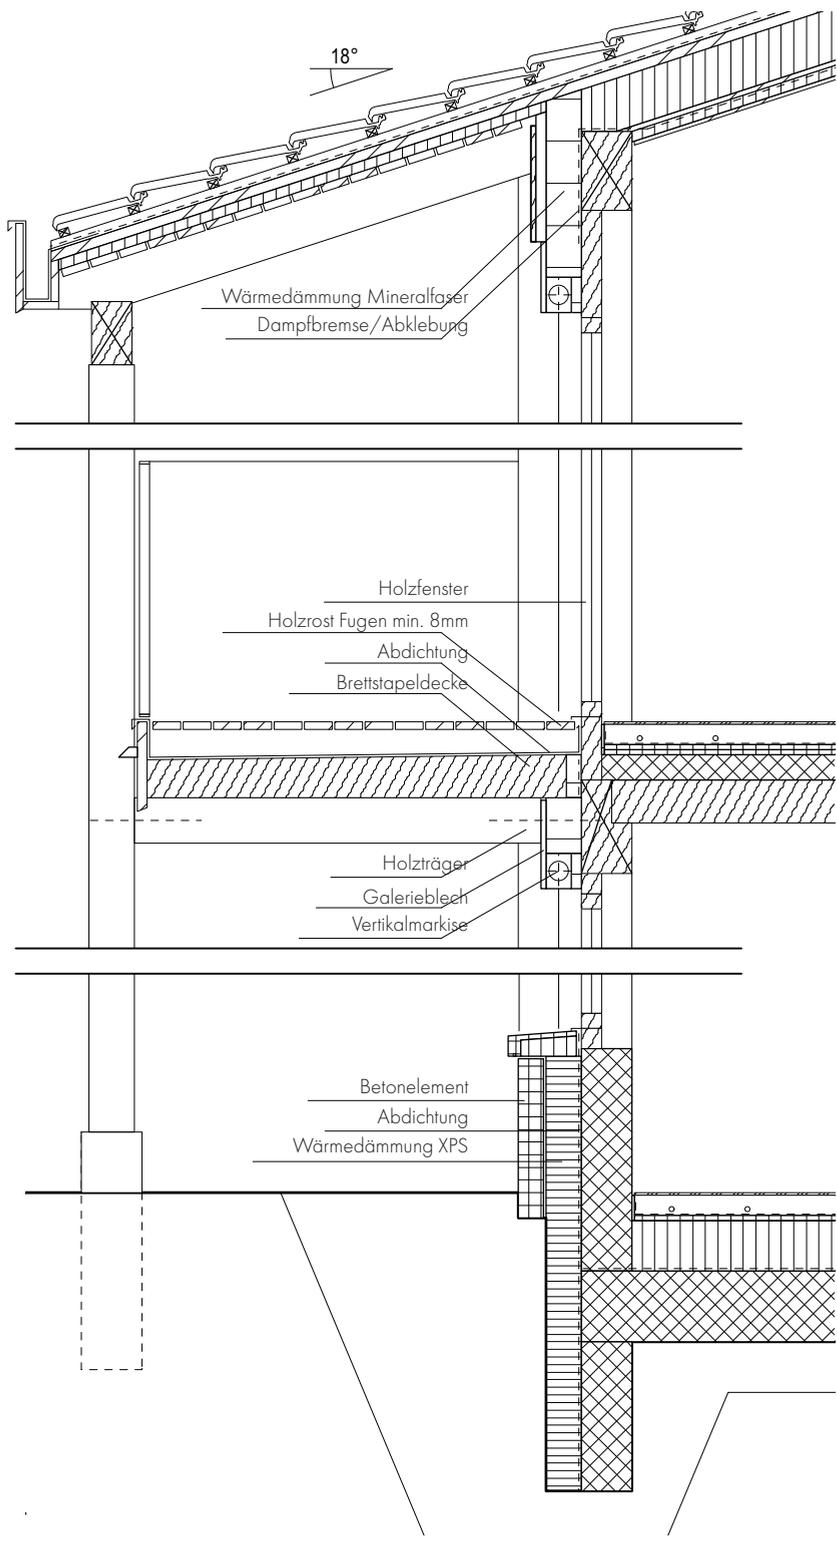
Konstruktionsschnitt Laubengang 1:30
